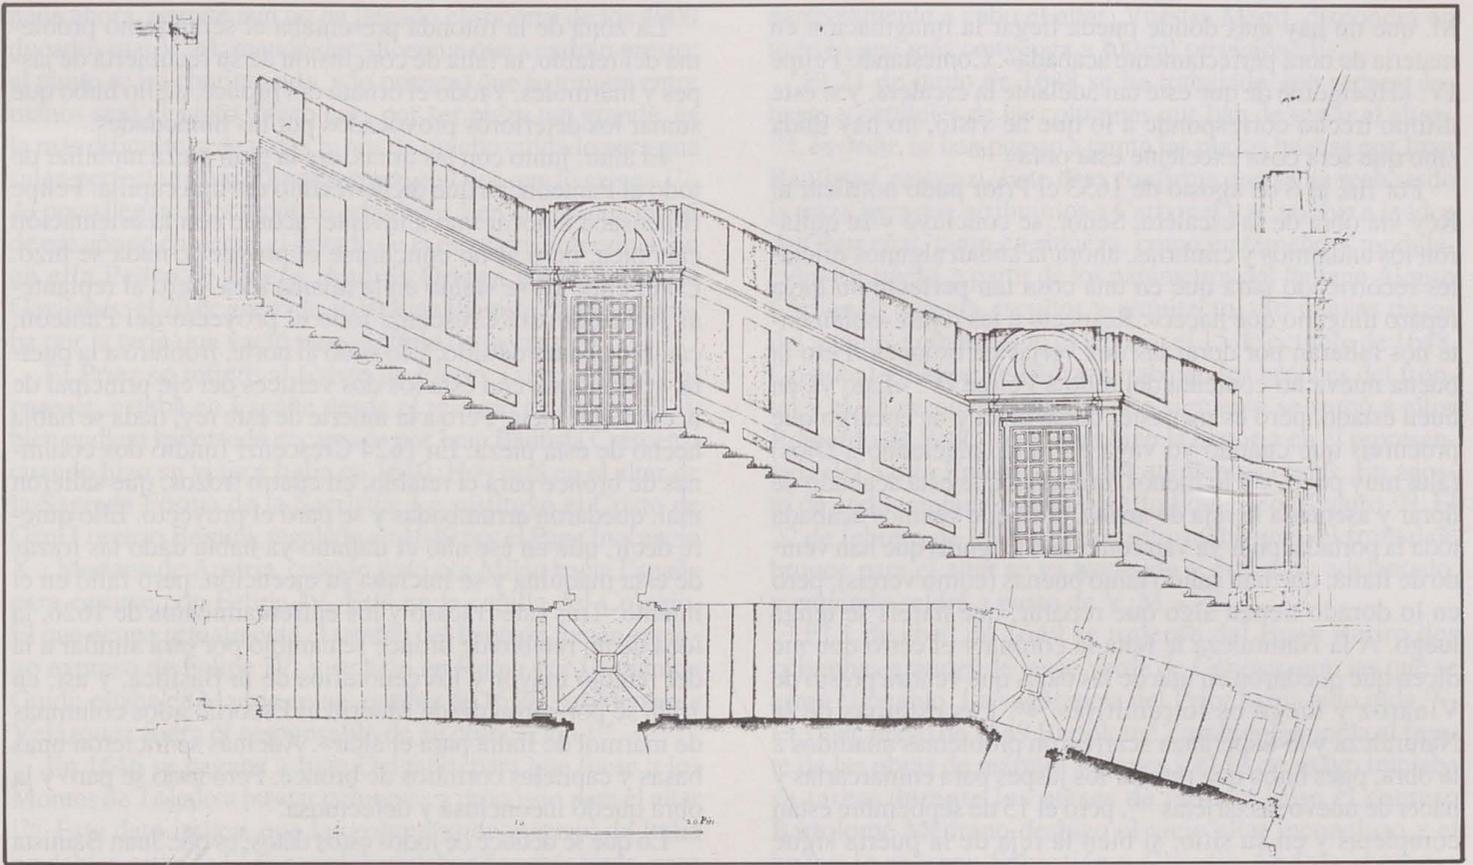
Pedro de Villafranca. Grabado con la planta y alzado de la escalera del Panteón del Escorial.
